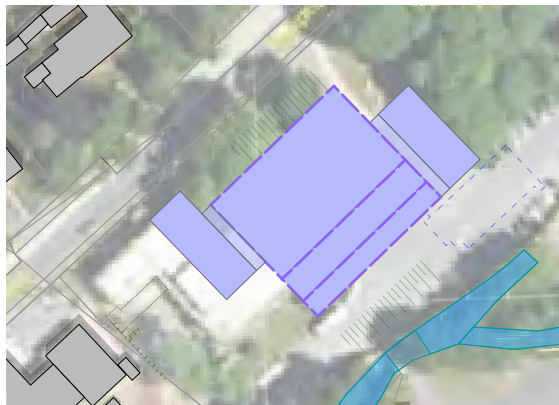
Lageplan Option Neubau mit Dreifachturnhalle
